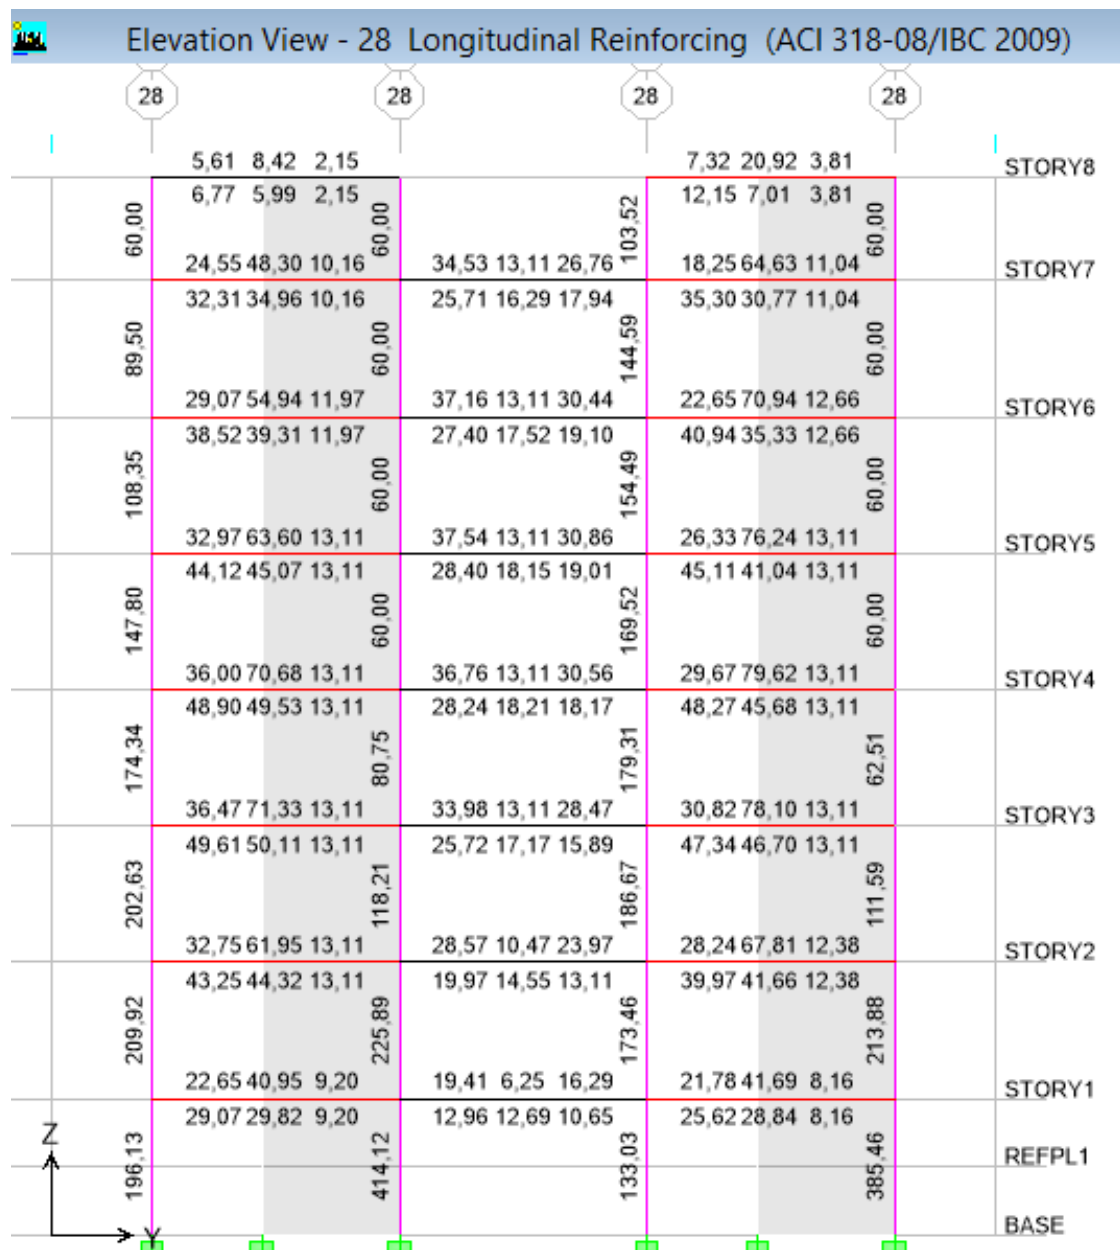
Acero en Vigas y Columnas en el Pórtico 28 – Hospitalización 2- (NEC-11)
